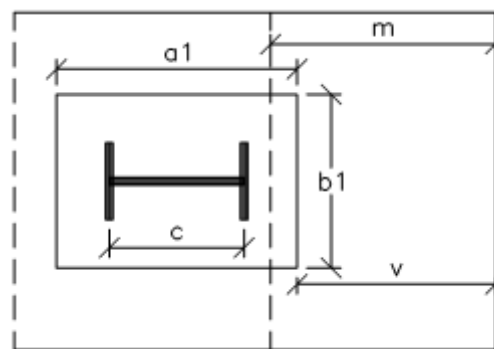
Vuelo de cálculo en una zapata con pilar metálico.
